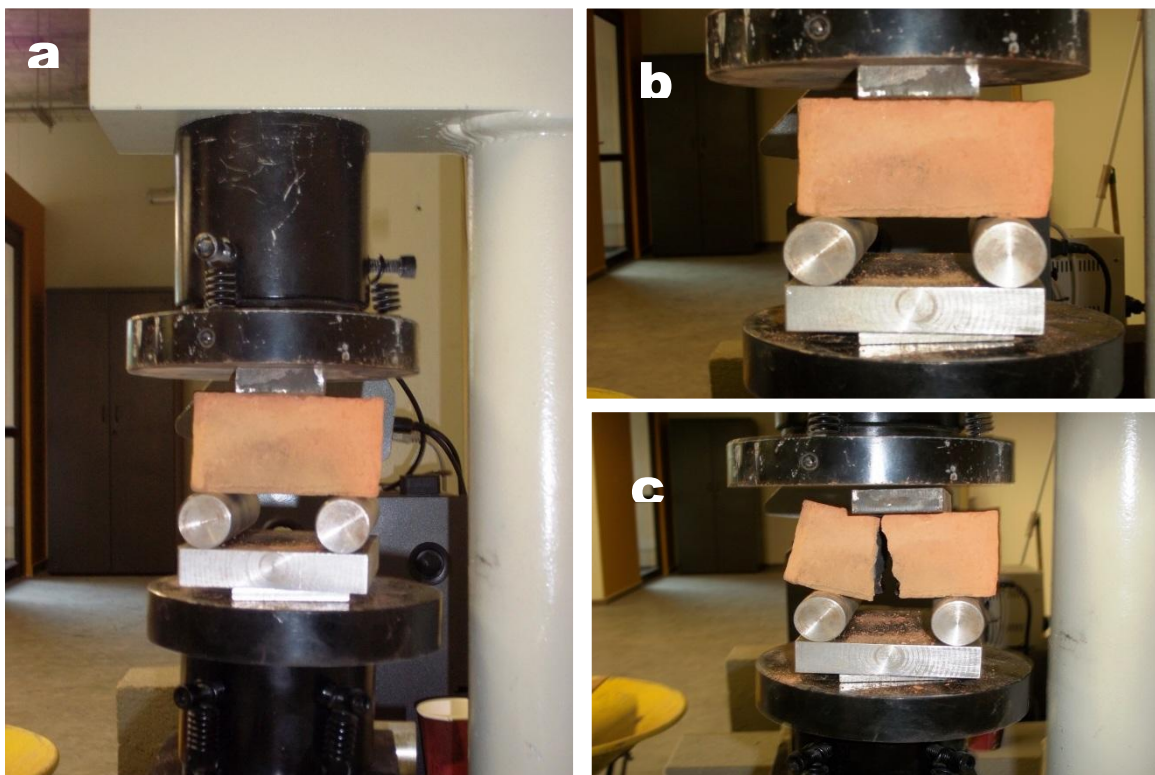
Montaje ensayo de rotura: A) Ubicación ladrillo en la máquina, B) aplicando la carga puntual y C) Ruptura del ladrillo. Fuente: Autor
